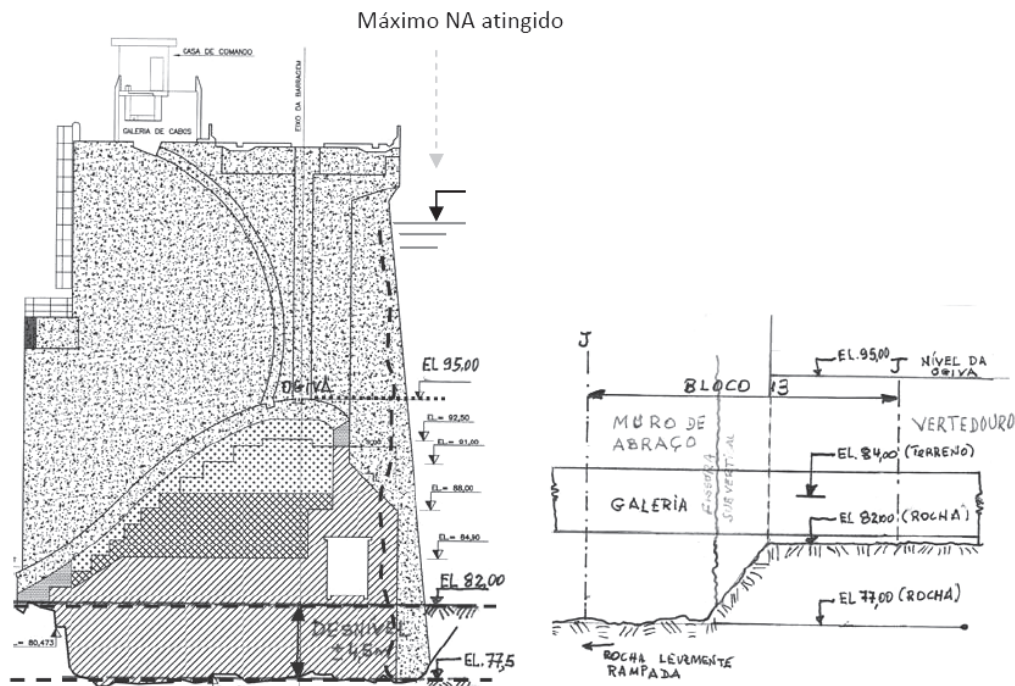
(a) Desnível - corte transversal (suposição da penetração máxima da fissura no muro de abraço - entre o paramento de montante e a linha traço interrompido), (b) Desnível - corte longitudinal, fonte: DNOCS (2015).
